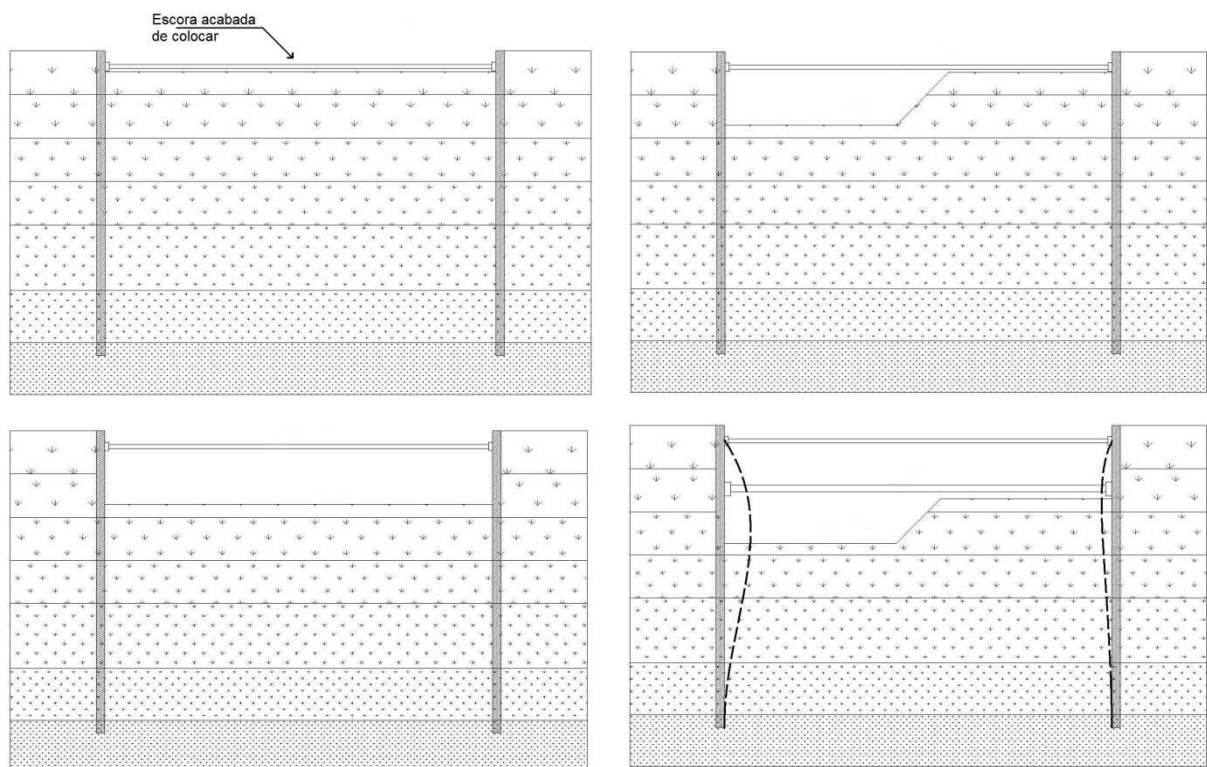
Pré-esforço com subfaseamento da escavação
